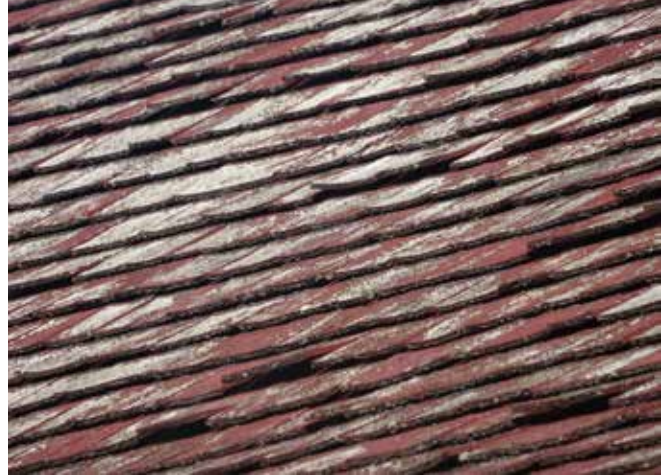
La toiture existante est en bardeaux de cèdre.
